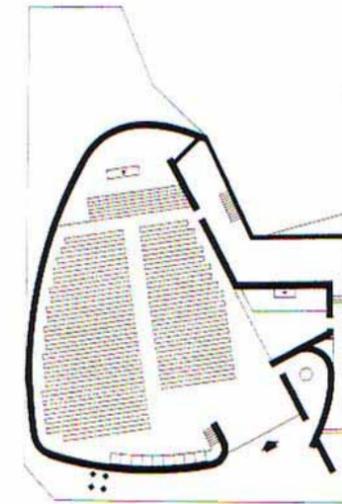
Grundriss, Kirche Krönung Maria, Vitoria, Spanien
